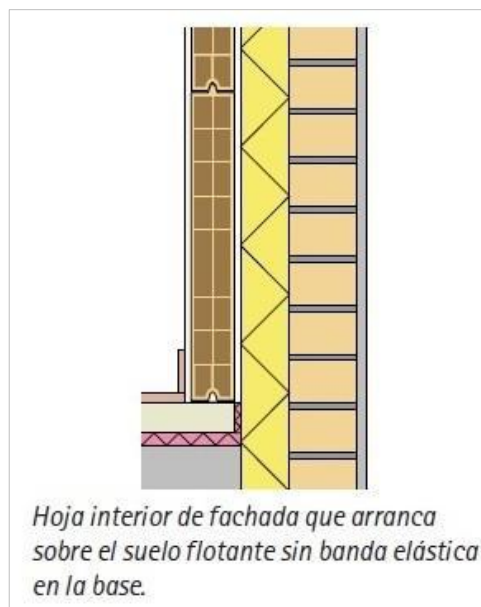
Tipos de arranque de las hojas interiores de fachada sin banda elástica
